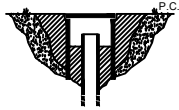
Pozzetto di protezione del tubo piezometrico posto nel sondaggio Pz\_3.
